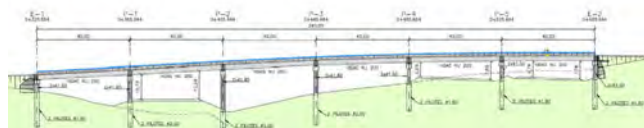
Alzado del tablero de la estructura E-12. Paso superior con tablero de pequeño ancho.
